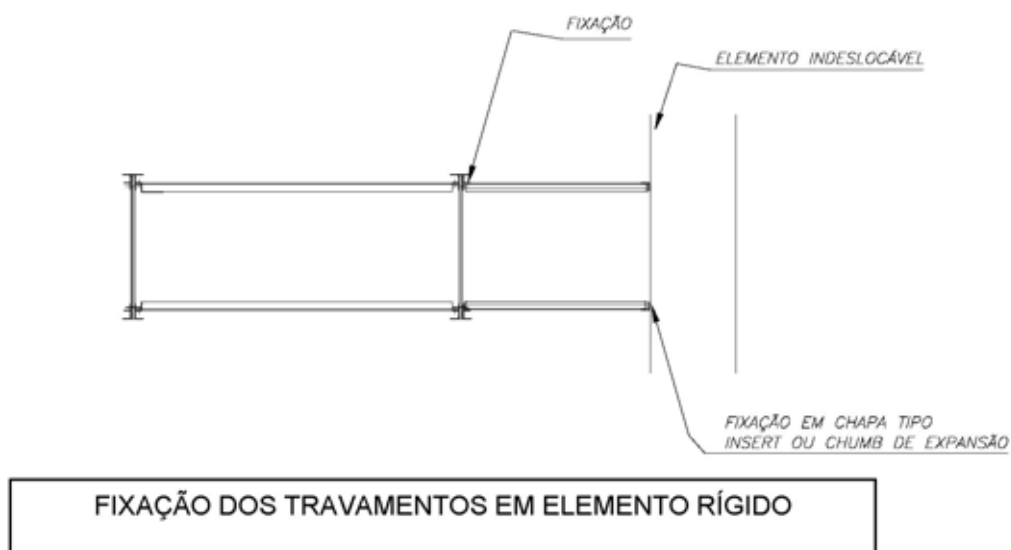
Ancoragem do Travamento Horizontal em Alvenaria ou Concreto
